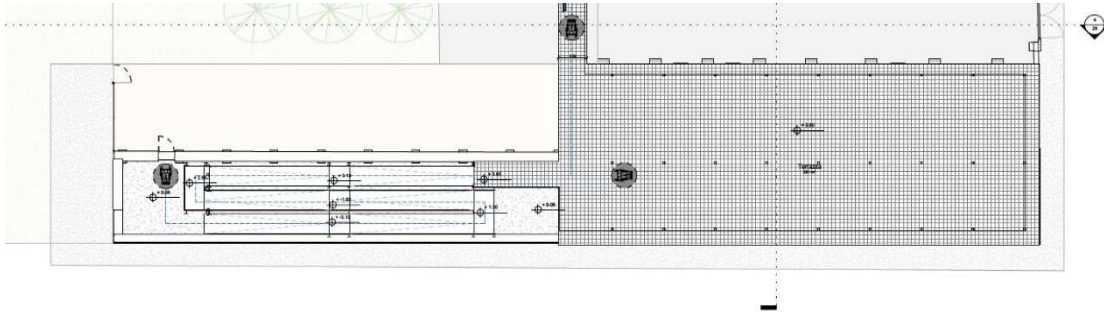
Ex-Galoppatoio - pianta piano primo Terrazza
